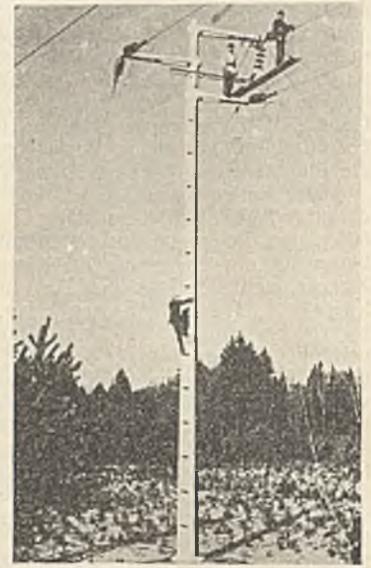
Montage des Abspannmastes einer 50 000-V-Leitung, beachtenswert das leichte Besteigen ohne Kletterschuhe.
